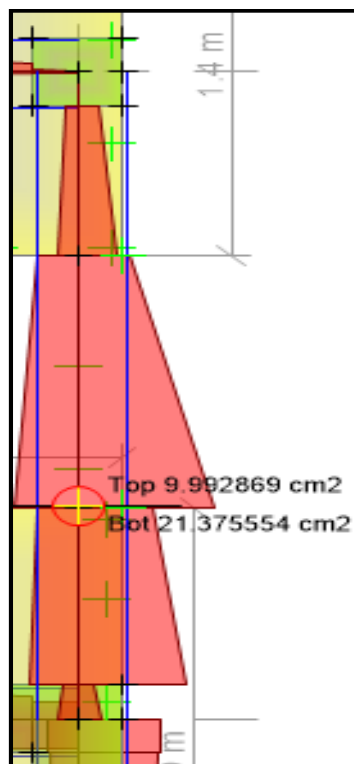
Detalle del acero en la viga de cimentación- Tramo de ejes B a eje C.
